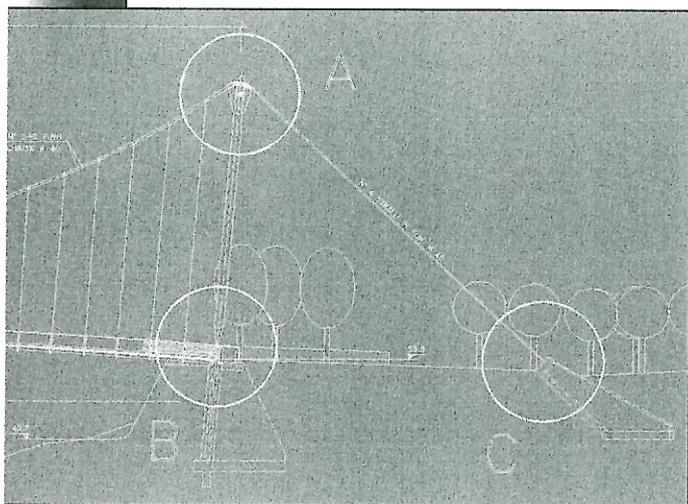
Il cavalletto d'ancoraggio: particolare B
